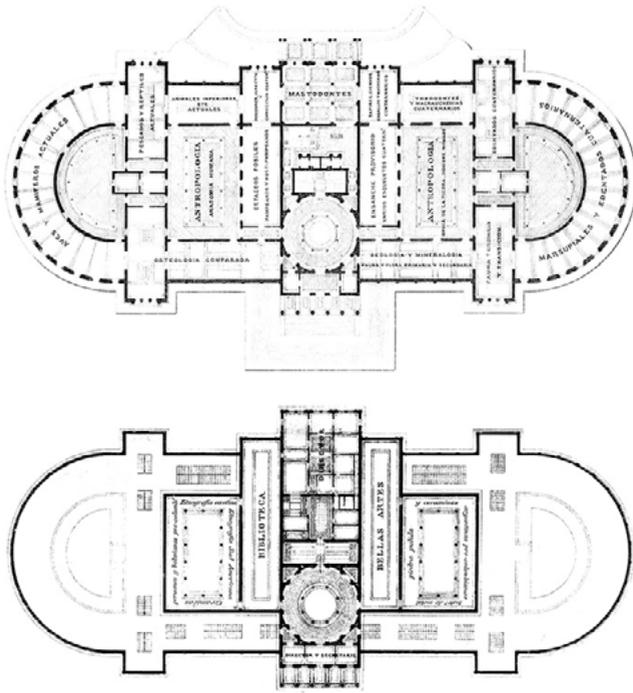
Plano de las plantas de acceso y superior del Museo (niveles 1 y 2), con la distribución de salas de exhibición en la época fundacional.
